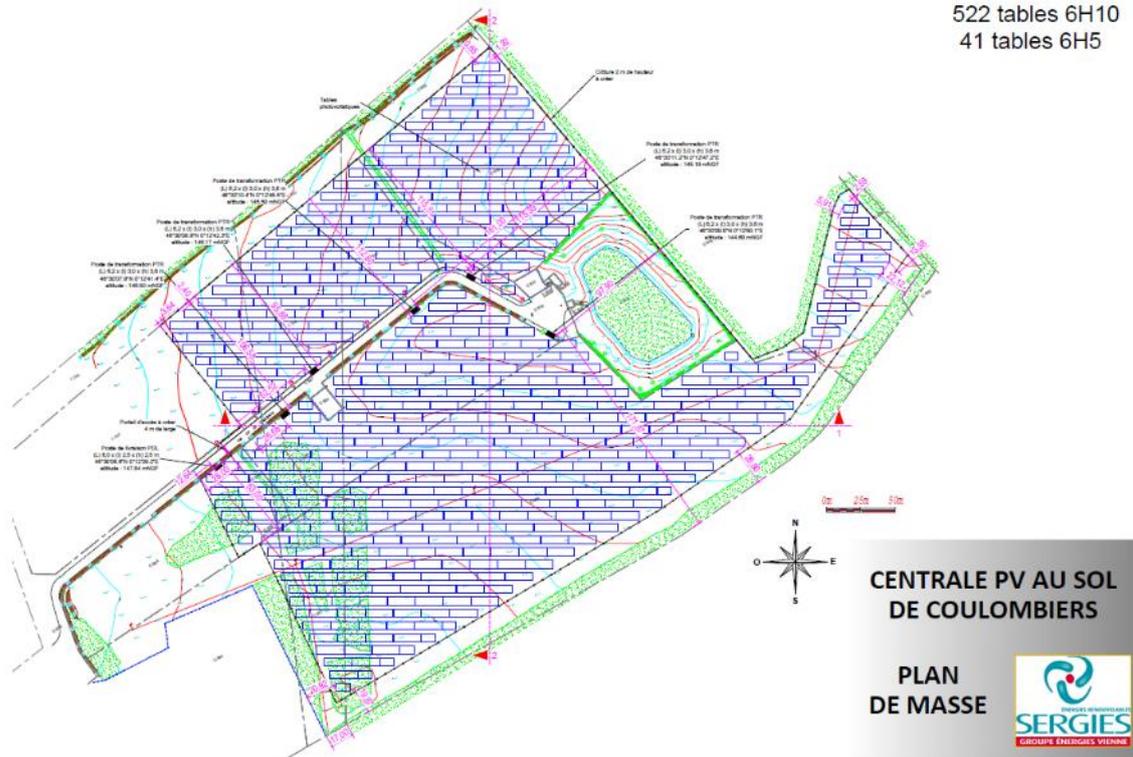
Plan d'implantation de la centrale photovoltaïque
